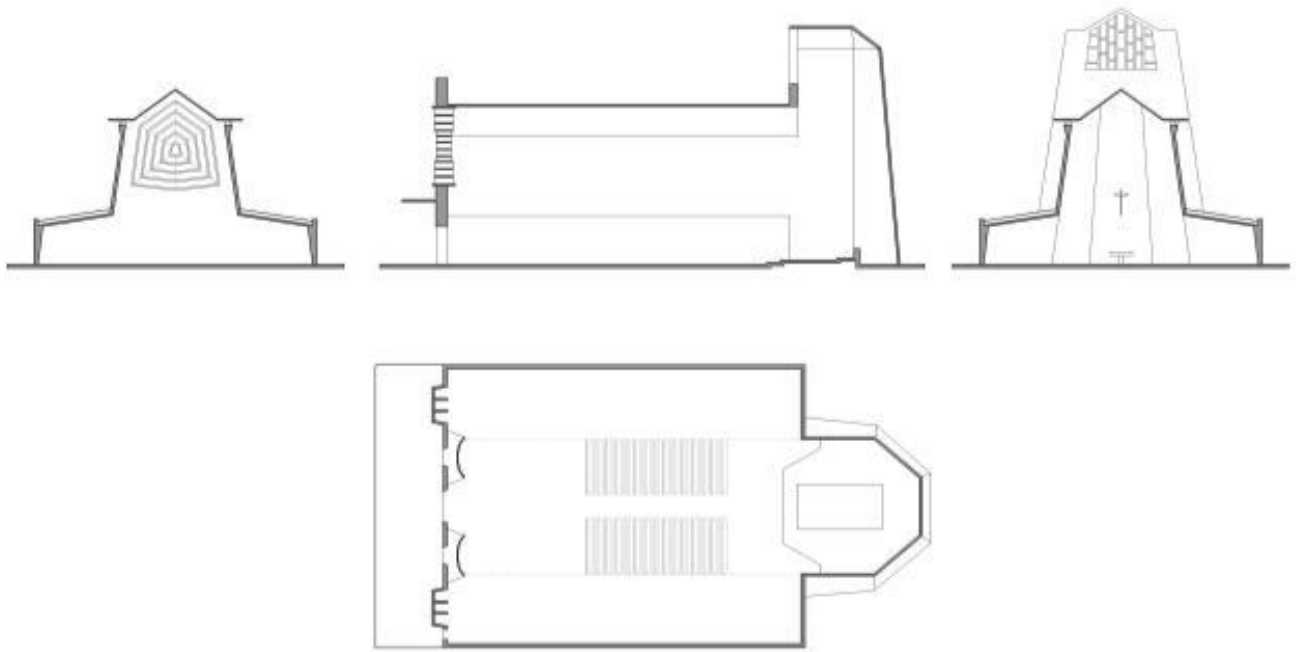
e 105: planta baixa, corte longitudinal e cortes transversais redesenhados
